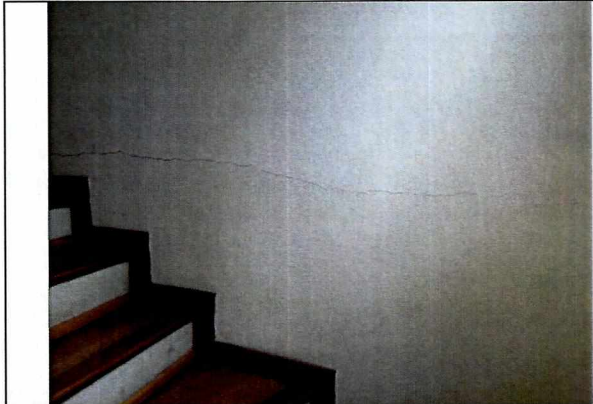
Fisura bajo escalera de acceso al segundo piso – 30 de enero de 2019
